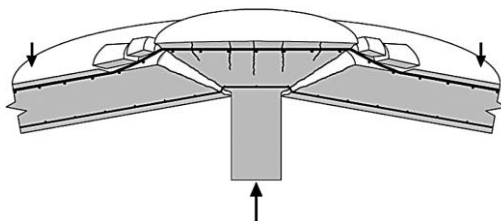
Механизм разрушения плиты перекрытия от продавливания
